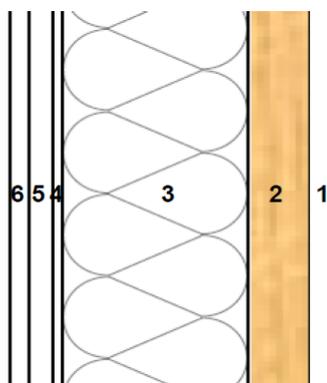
Detailausschnitt Außenwand Holzbau, Fallstudie 1.
